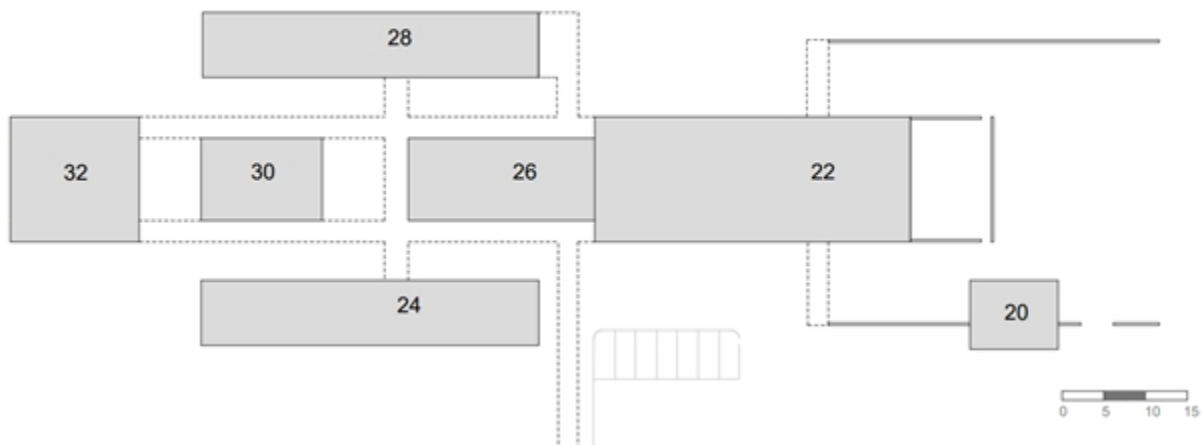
aktueller Übersichtsplan mit Nummerierung der Gebäude des ehem. Heerde-Kollegs
